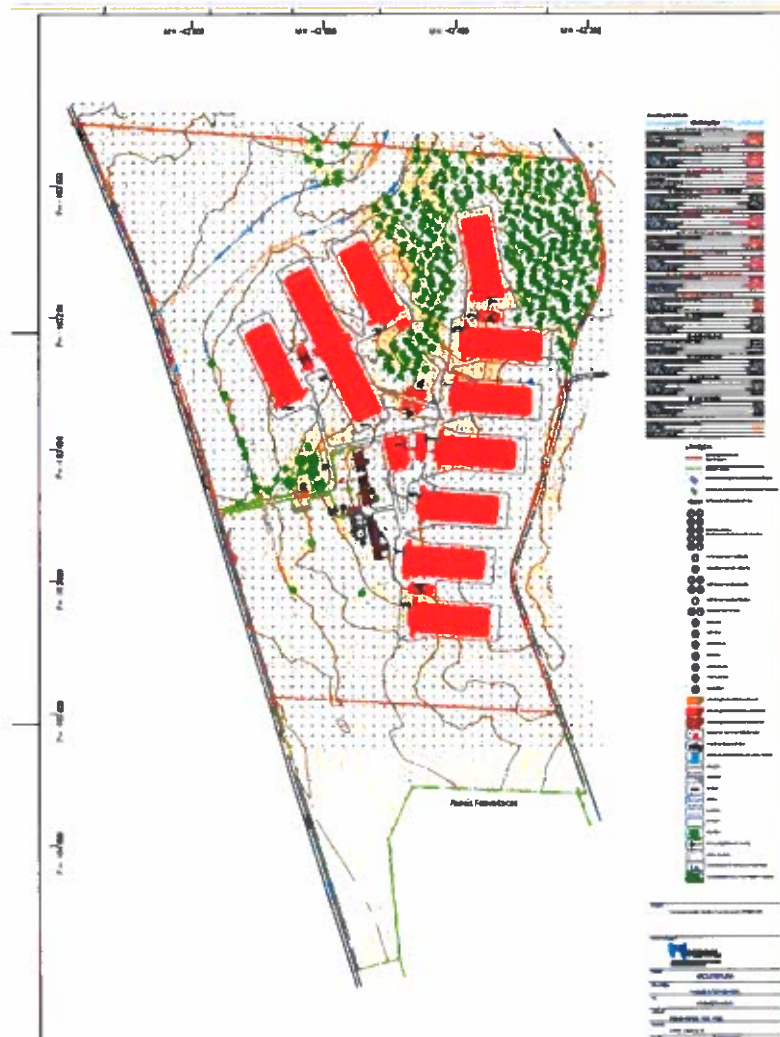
Planta de Implantação (Fonte: Anexos III- v2, agosto 2025)
